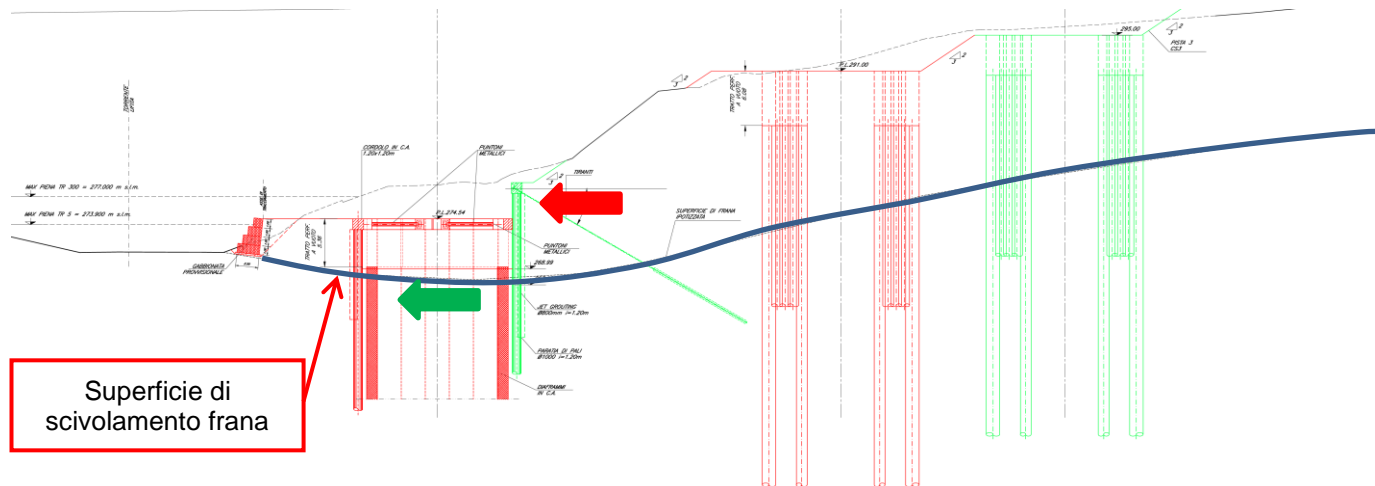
Sezione longitudinale in asse viadotto e visualizzazione delle opere di sostegno scavi della Pila P2 – (verde opere di fase A, rosso opere di Fase B)
